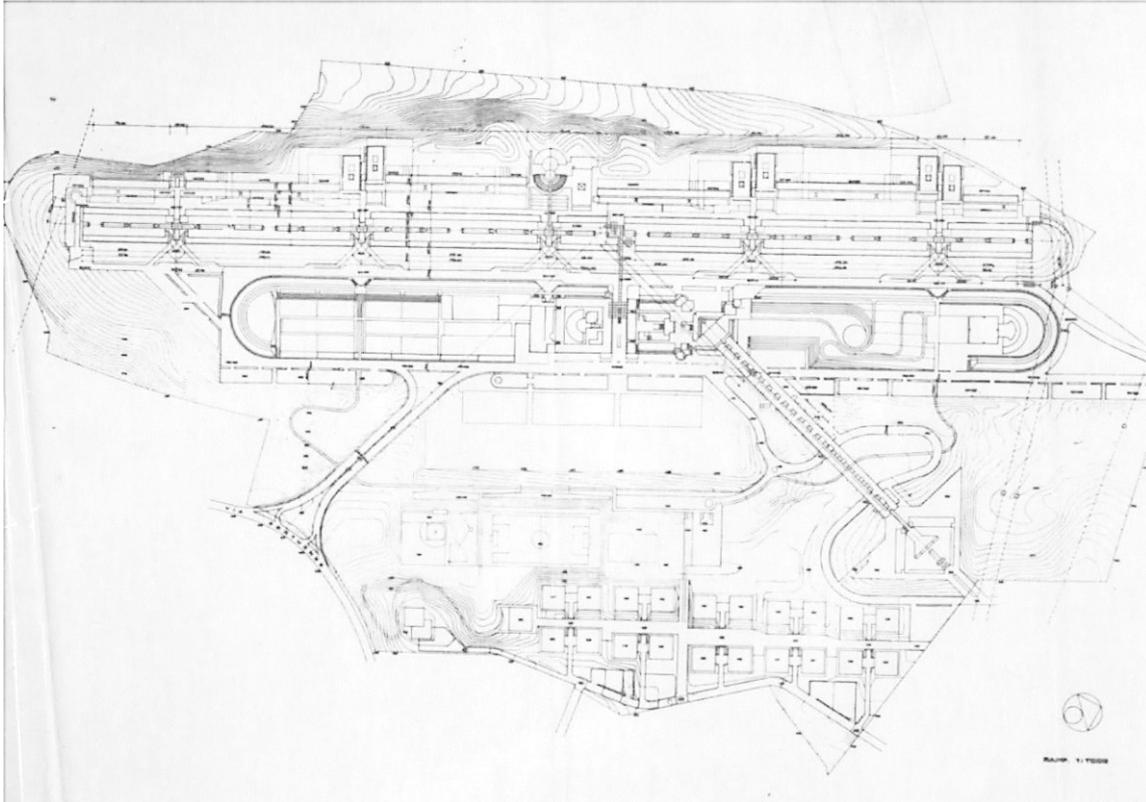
|Il Corviale_ Planimetria di progetto scala 1:1000
